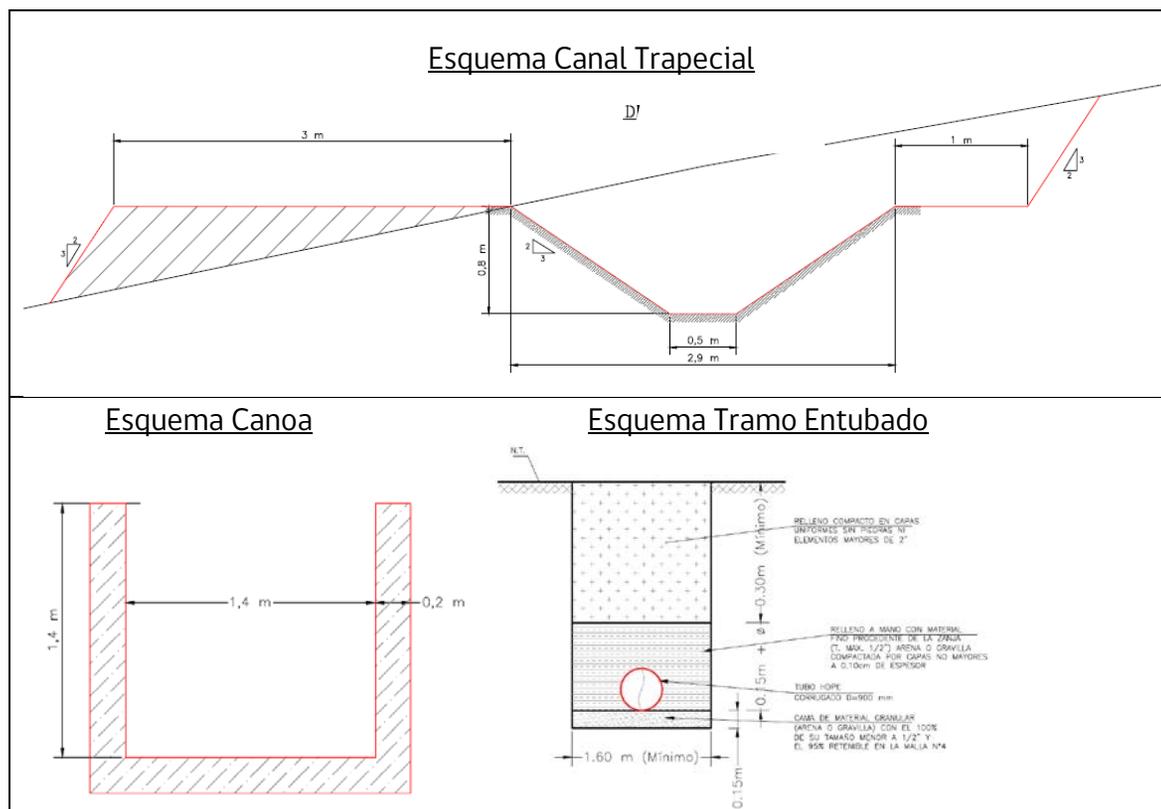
Esquemas Secciones Canal San Fabián
